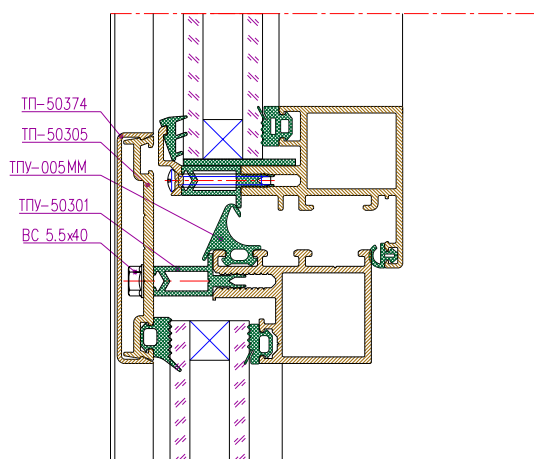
Установка уплотнителя ТПУ-005ММ, термовставки ТПУ-50301 на участках со скрытой створкой
